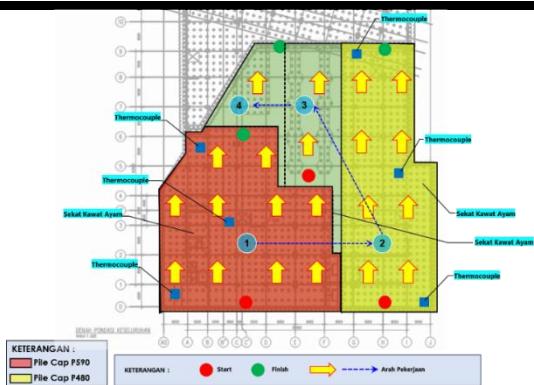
Zonasi Pekerjaan Pondasi Spun Pile
